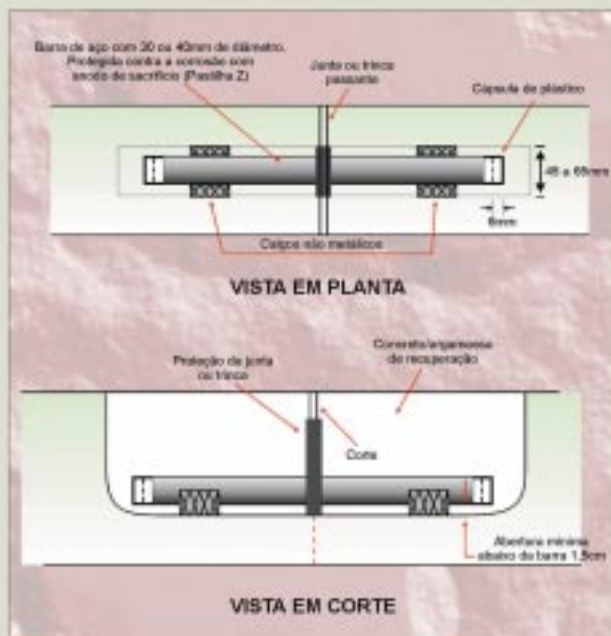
B - Detalhes da instalação das barras de transferência seja aplicada em juntas ou trincas com cedência.
